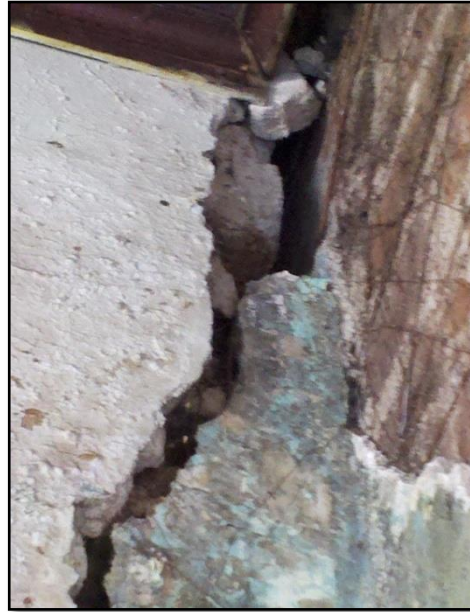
y Figura 5.20 Muestran las fisuras entre paredes perpendiculares.
